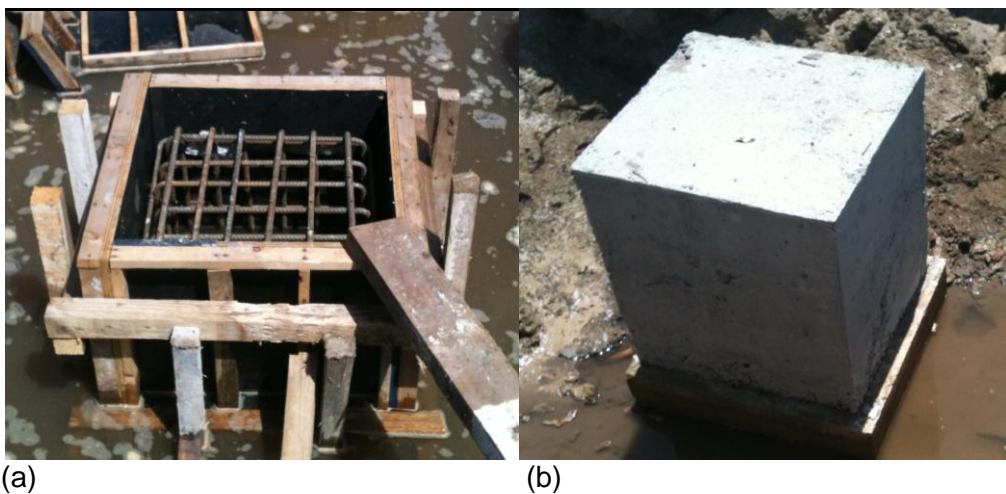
Bloco de coroamento, (a) forma e armadura; (b) bloco concretado.
